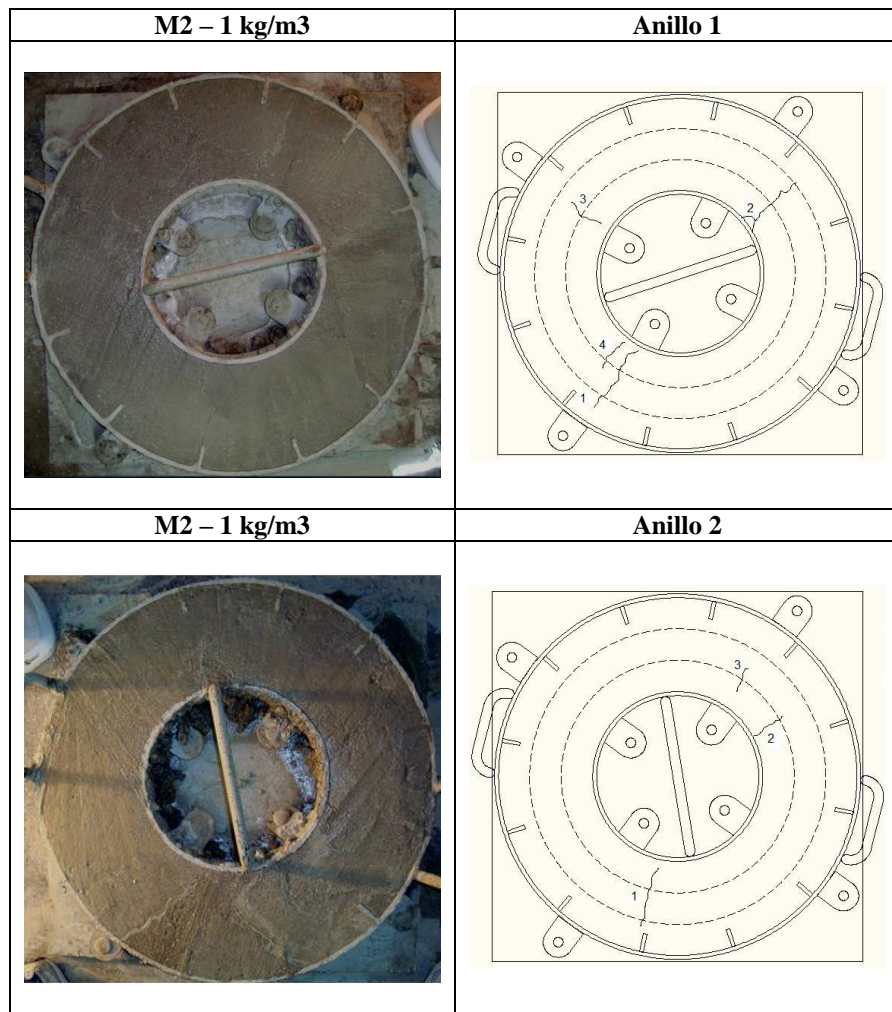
Grietas de Contracción Plástica de la Mezcla 2
